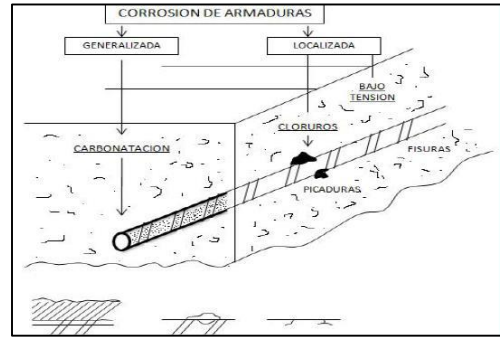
Tipos de corrosión de armaduras de concreto
